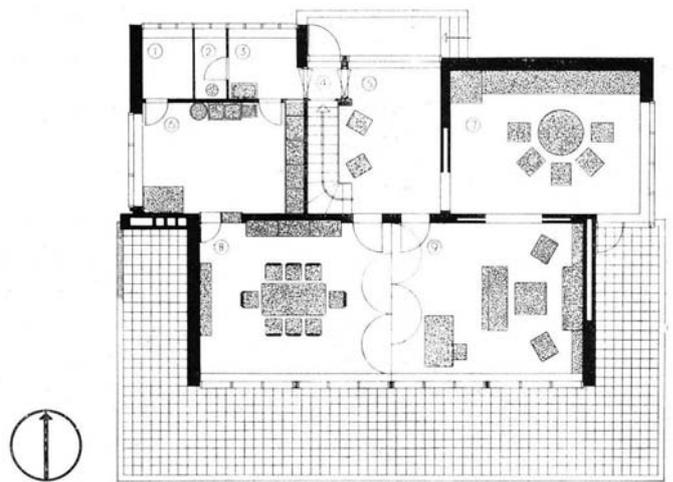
Erdgeschoss Grundriss Haus Müller Drenkberg, o.D.
